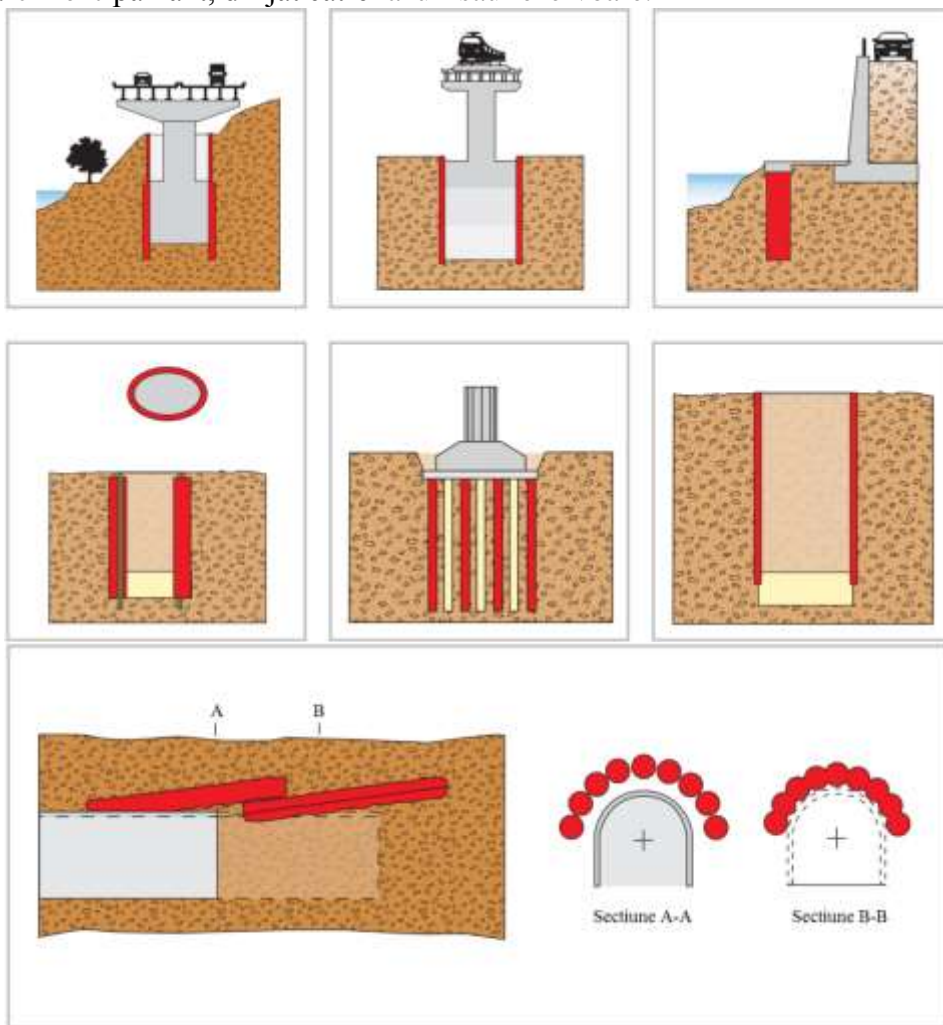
Exemple de utilizare a coloanelor de rocă stabilizate prin jet-grouting[4]
